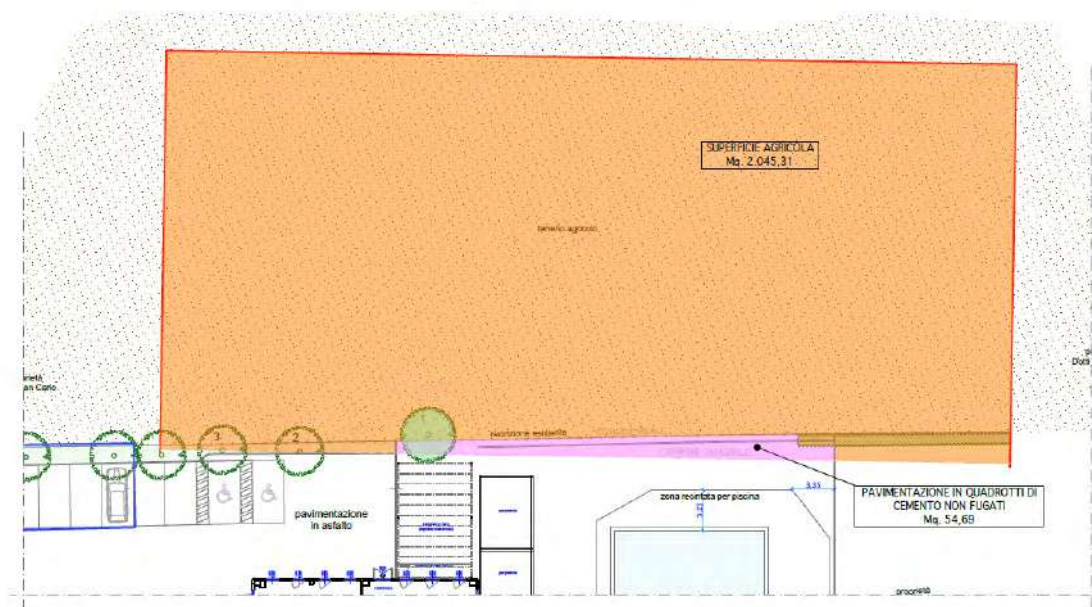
Planimetria dello STATO DI FATTO (in rosso il perimetro del lotto in esame)
